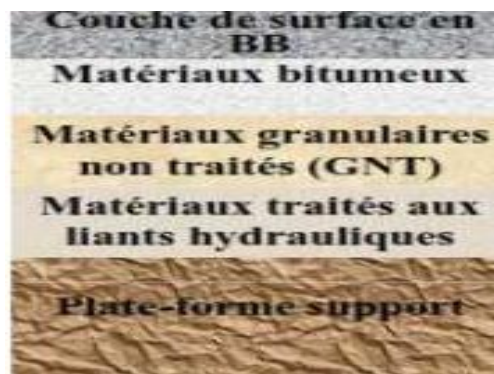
Coupe type d'une chaussée inverse ^[9]
